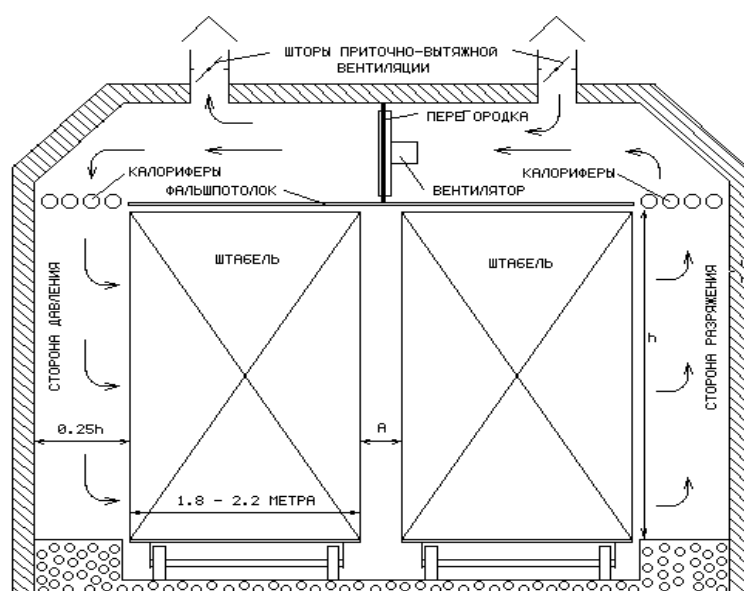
Конструкция сушильной камеры древесины с верхним расположением вентиляторов.
